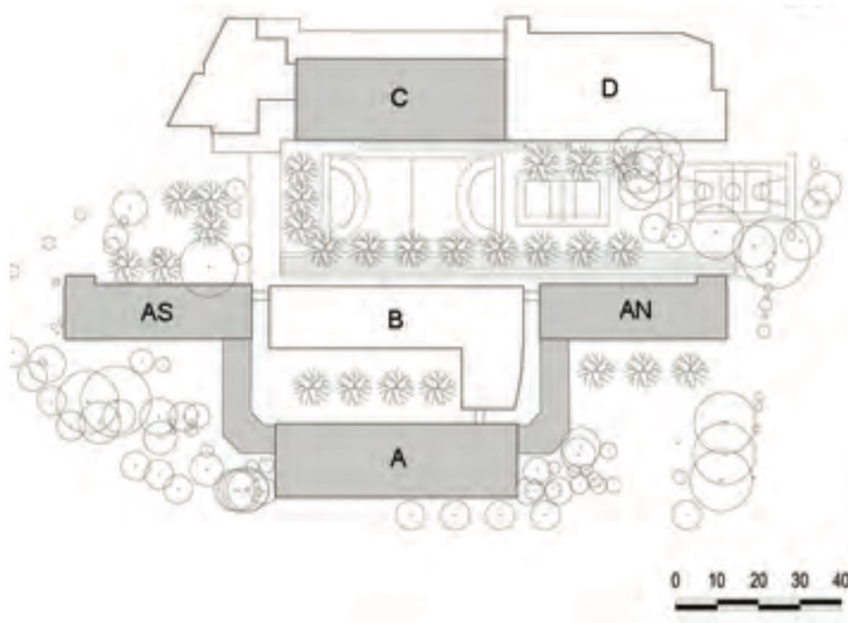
Planta de implantação da escola Secundária Pedro Nunes [23]
